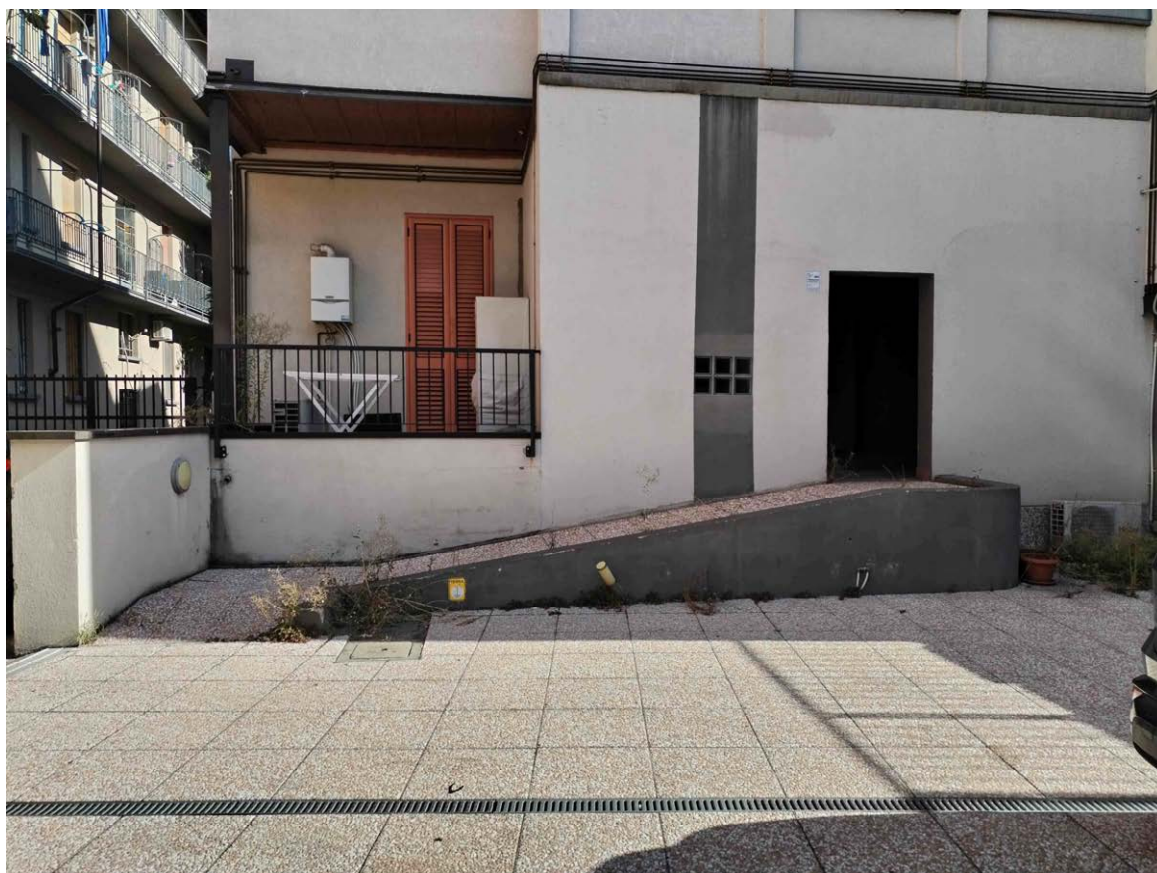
Rampa d'accesso comune al vano scale comune (mapp.98 sub.709)
